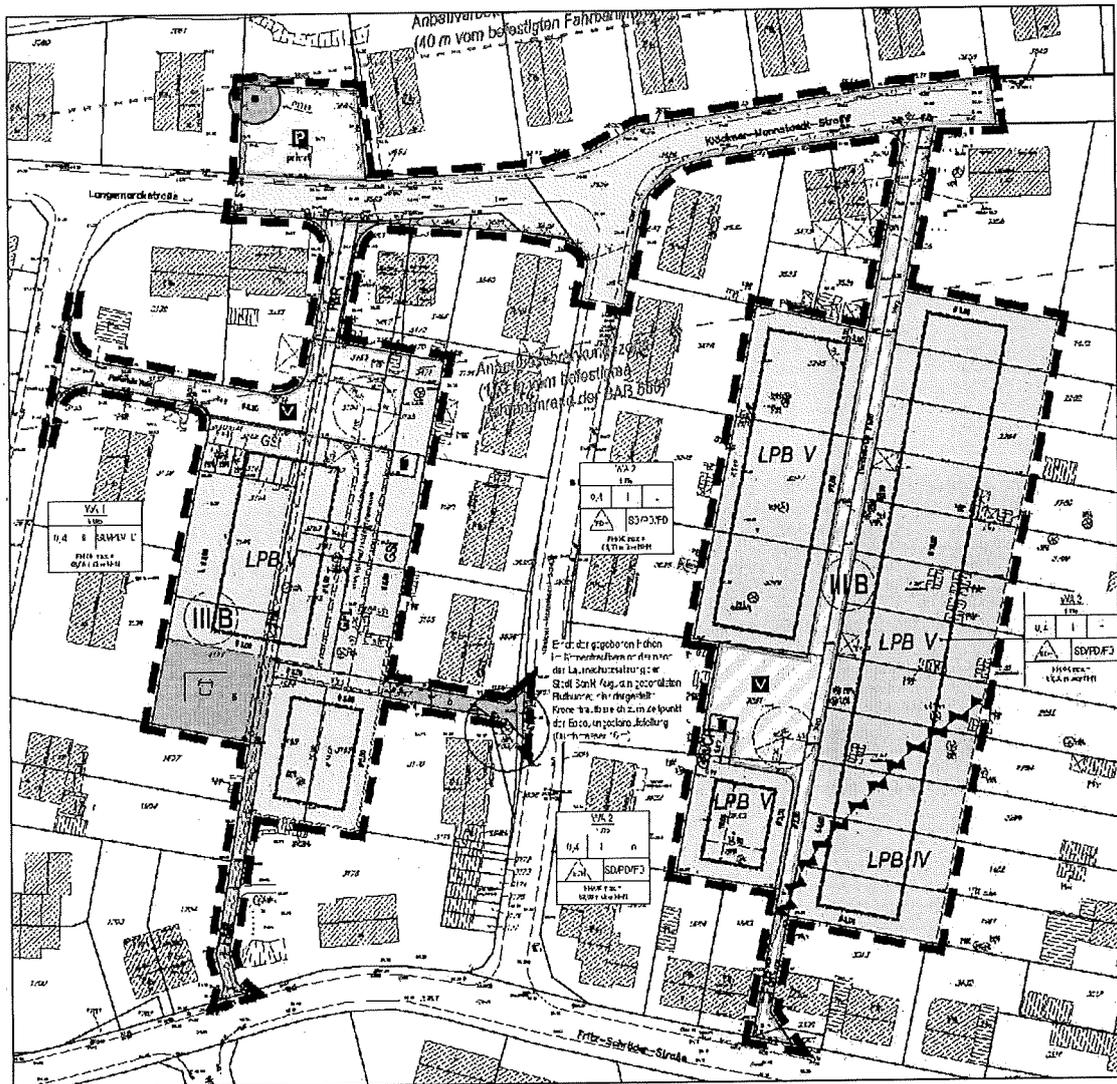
Ausschnitt aus der Planzeichnung des BP Nr. 417 /1/
